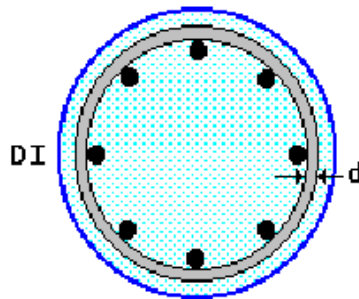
Diámetro mínimo de varillas longitudinales y utilizadas en zunchos.
